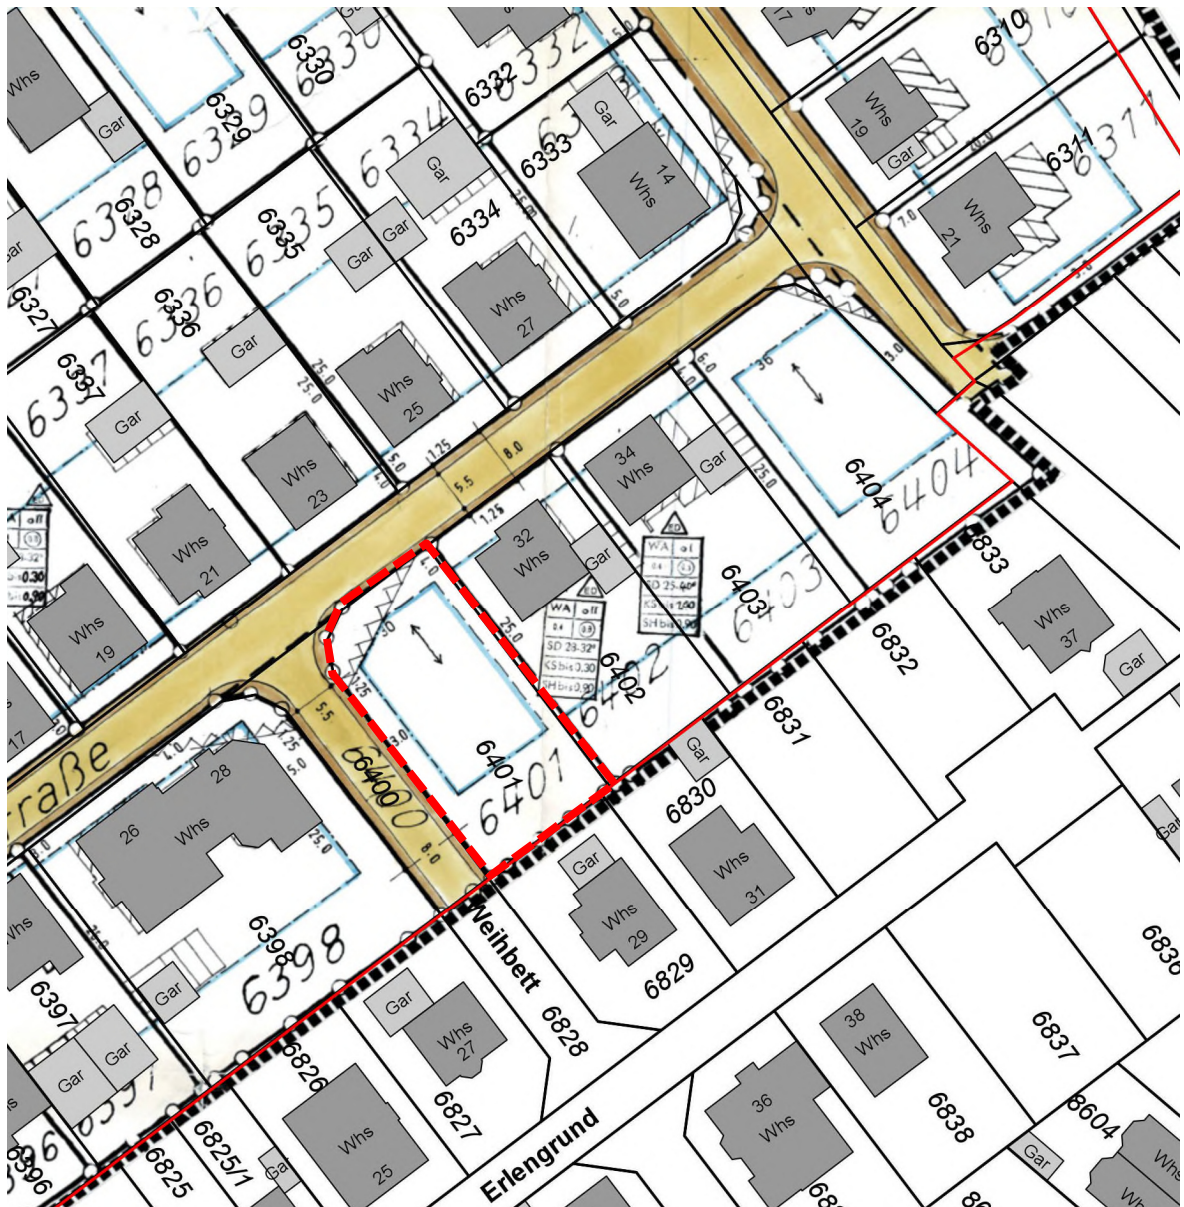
Ausschnitt Bebauungsplan „Überrück“ mit überblendetem aktuellen Kataster und Änderungsbereich (rot)
